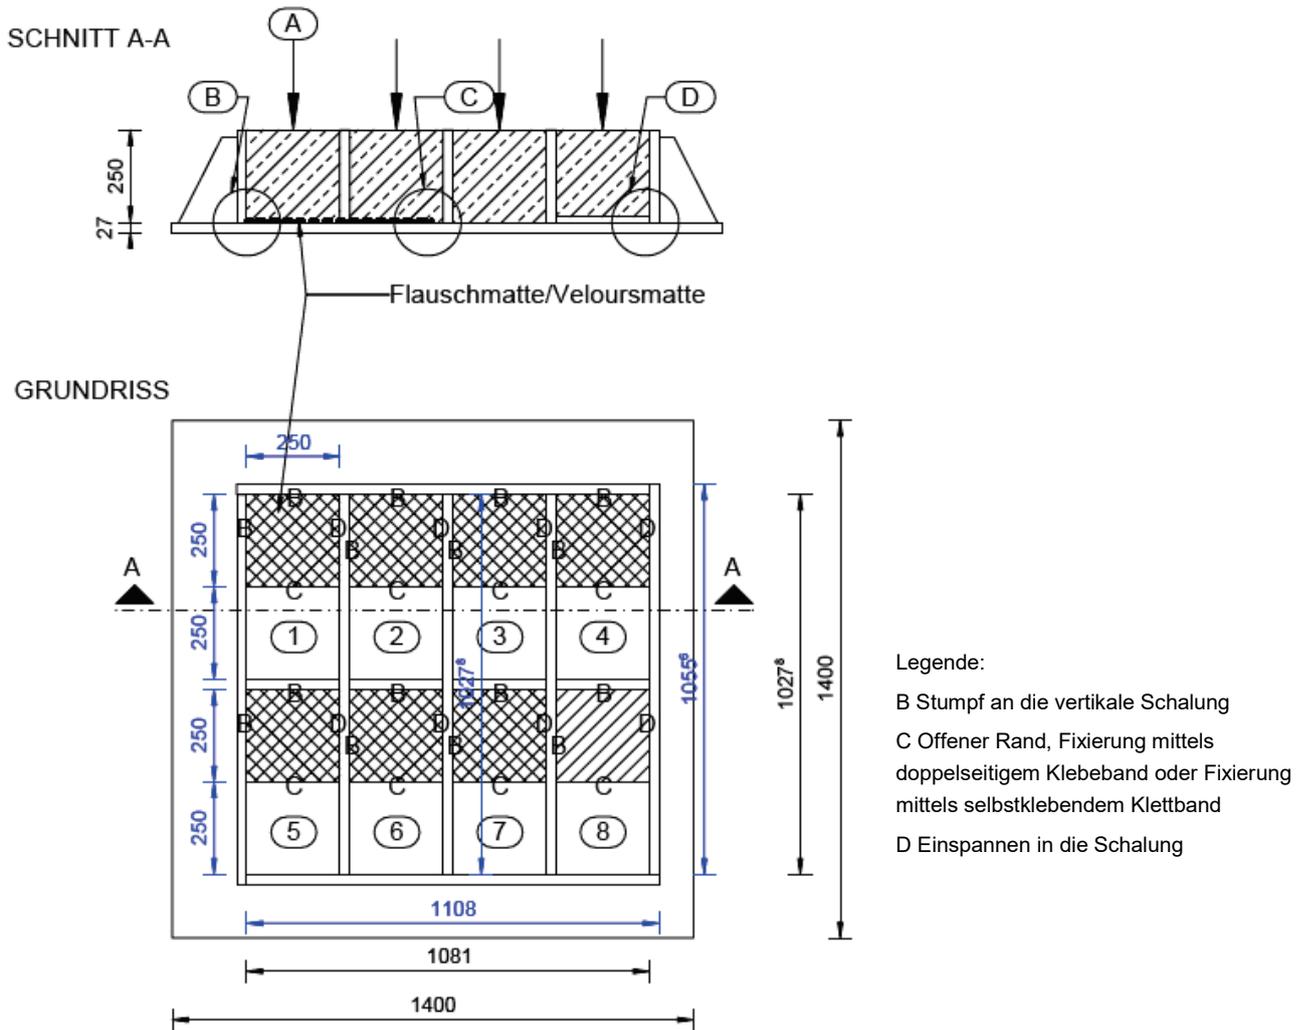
Versuchsaufbau mit Einlegesituationen, Plan Institut für Konstruktiven Ingenieurbau, TU Graz
